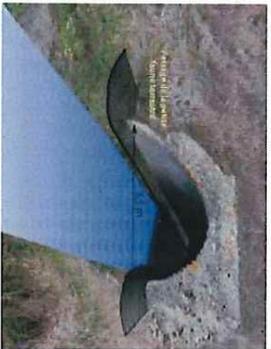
Principe d'aménagement de banquettes pour la petite faune terrestre dans un ouvrage hydraulique ©O.G.E.
